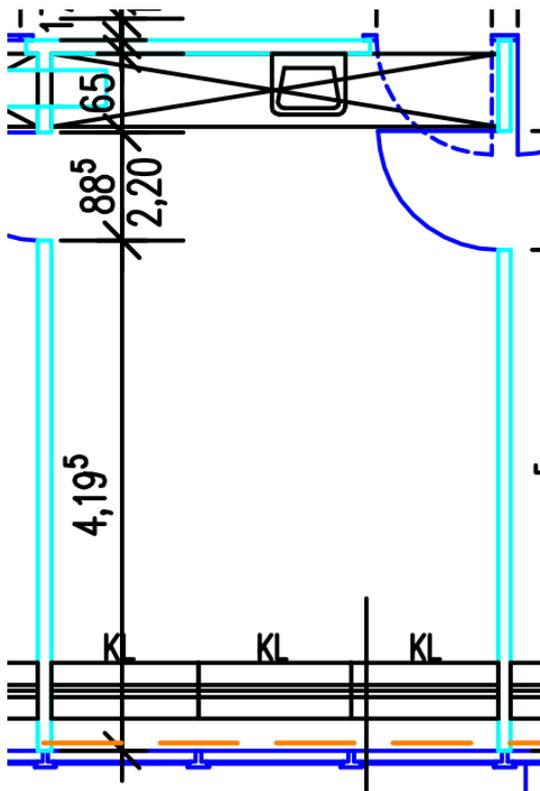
Grundriss: Standardbüro Bestand
